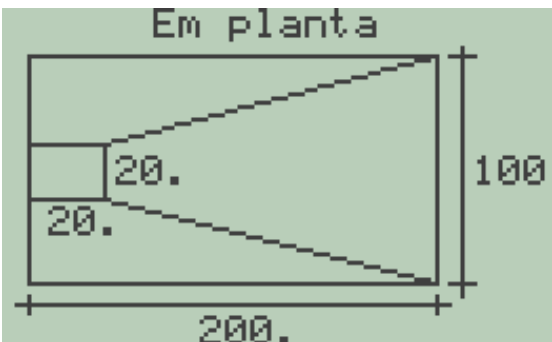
Sapata em divisa - Detalhamento da sapata em planta.
